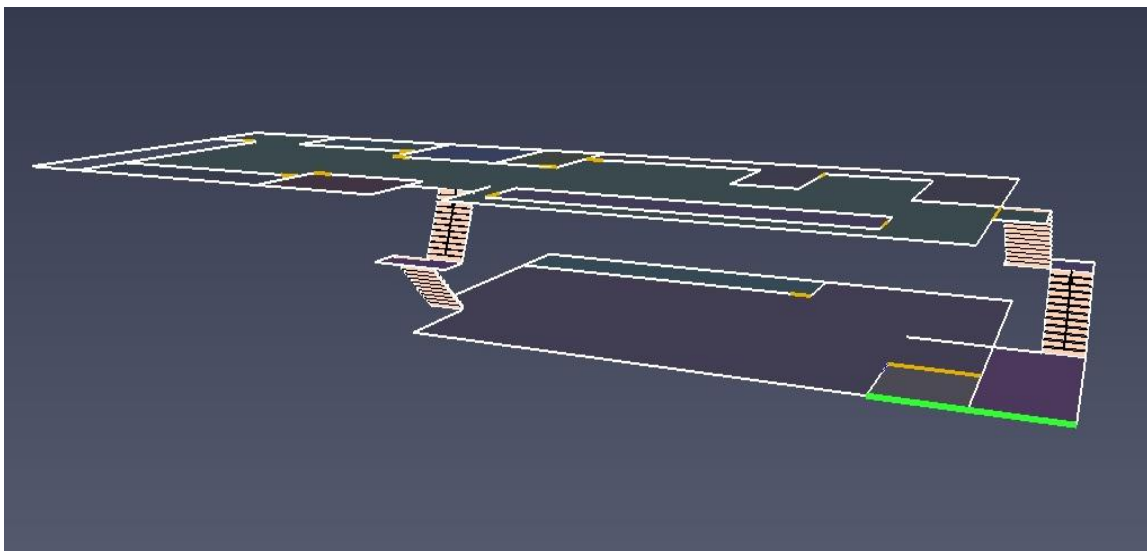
“Vista general en 3D de las plantas de primer y segundo piso de la discoteca 2 en Pathfinder.”
